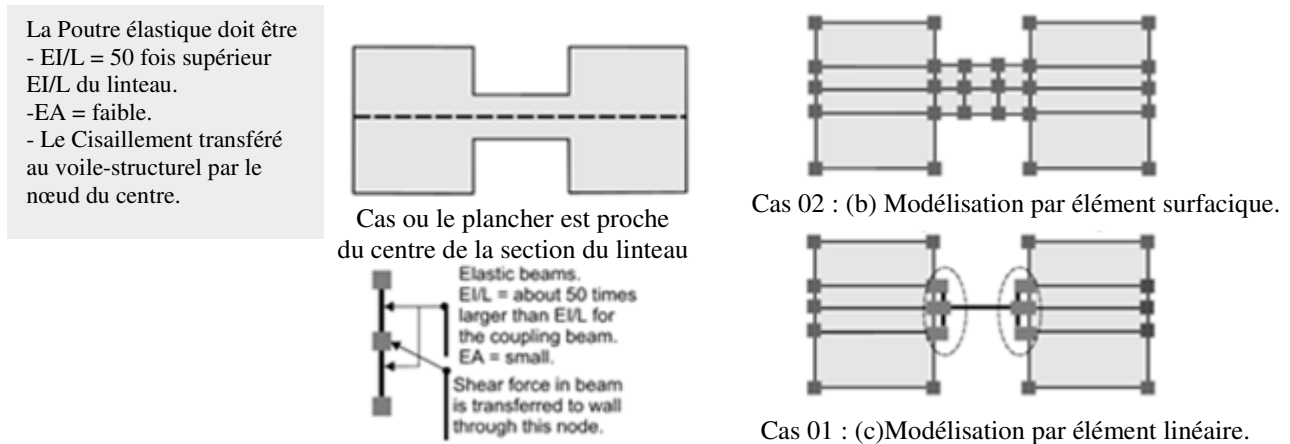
Poutre- linteau modérément profonde « niveau dalle encre au niveau du linteau »[53].
